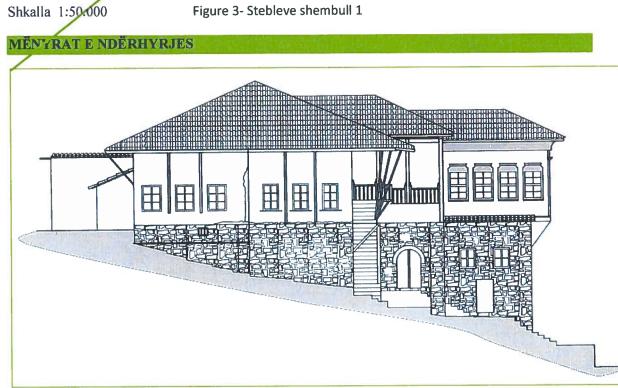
NDËRTESA KRYESORE : pamje tip, Stebleve shembull 1
